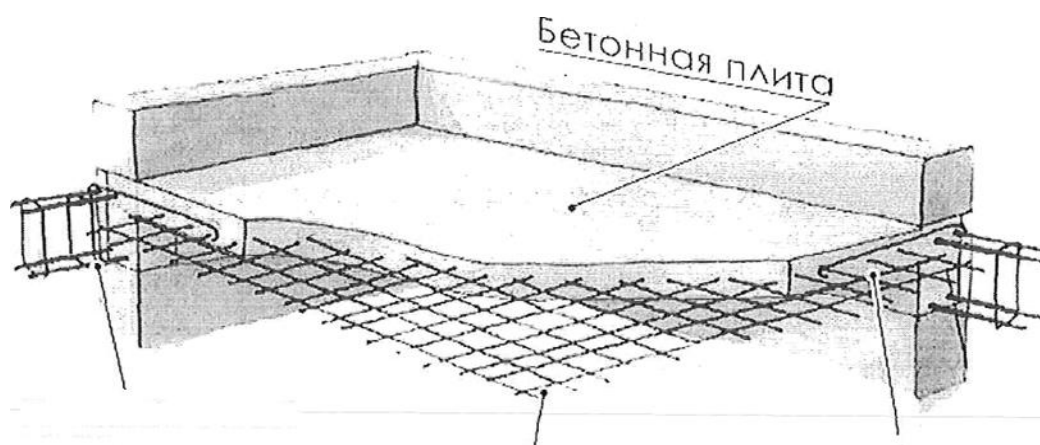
Схема армирования монолитной плиты перекрытия
